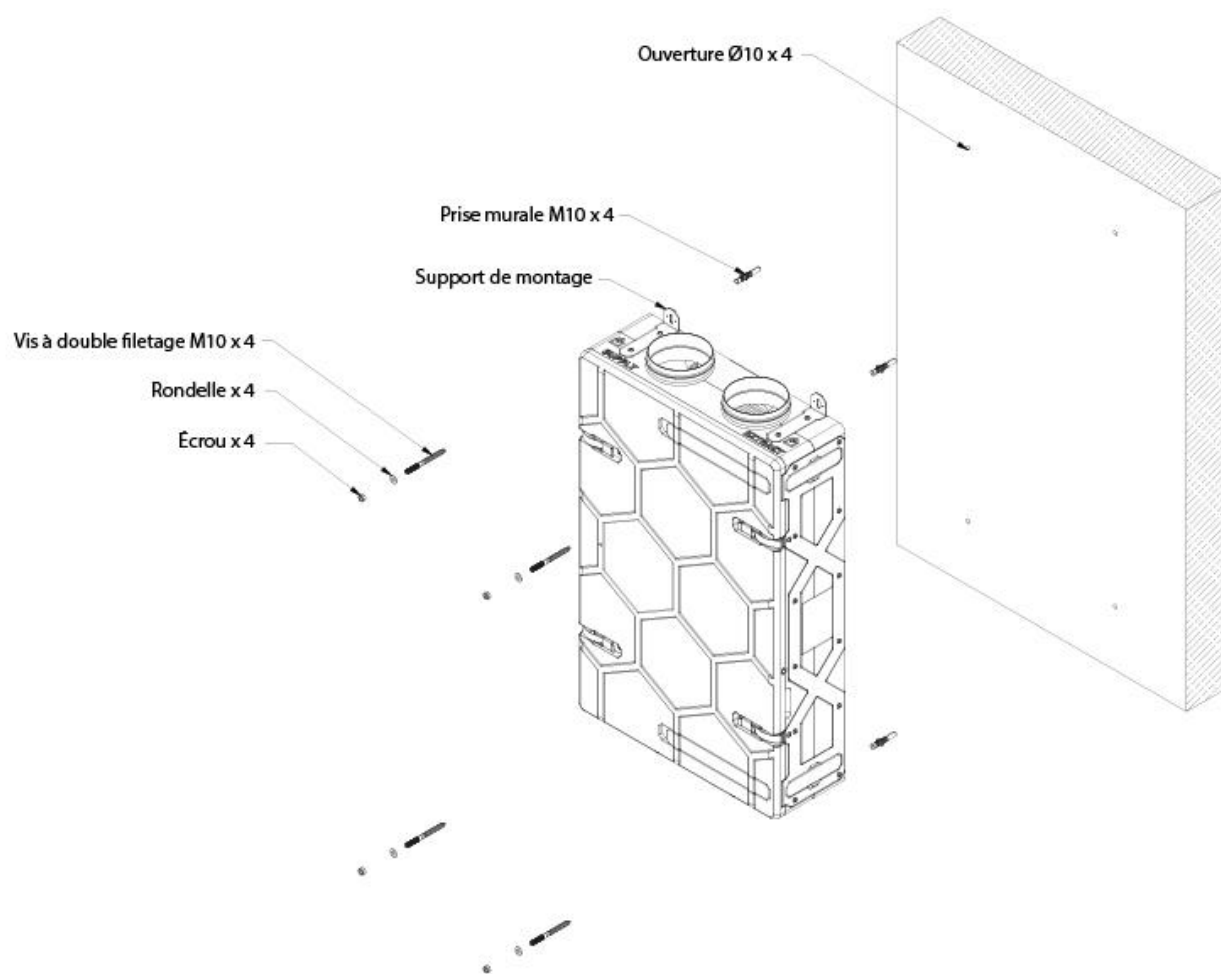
Installation verticale de l'unité avec kit d'installation standard
